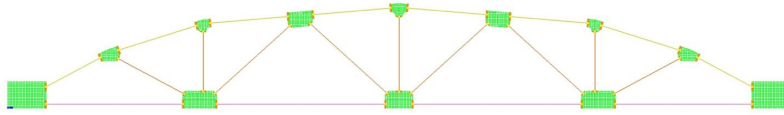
Загальна розрахункова схема конструкції залізобетонної ферми
